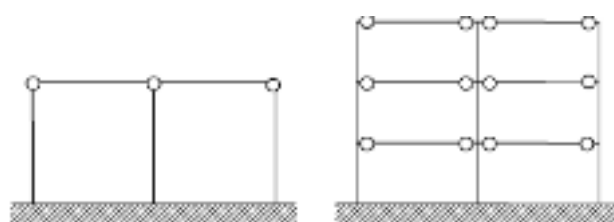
Estruturas em pórticos com ligações articuladas
